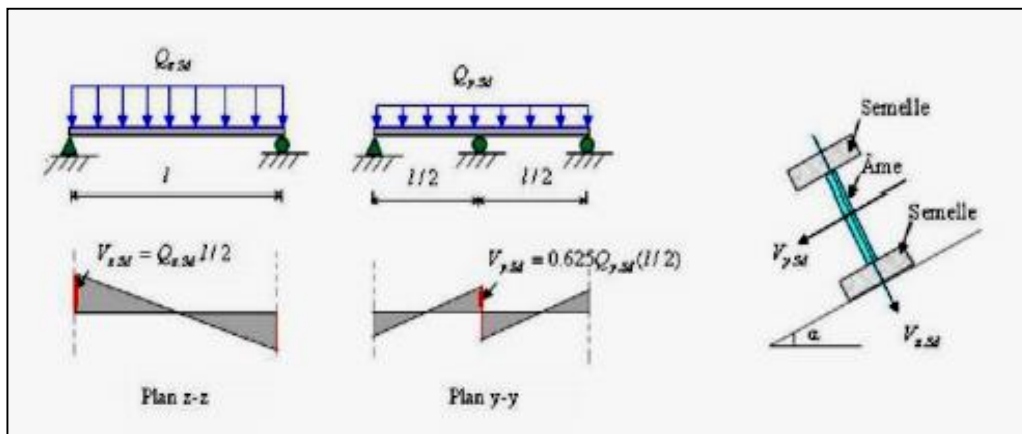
Panne de toiture en cisaillement sous les différents plans de chargement.
